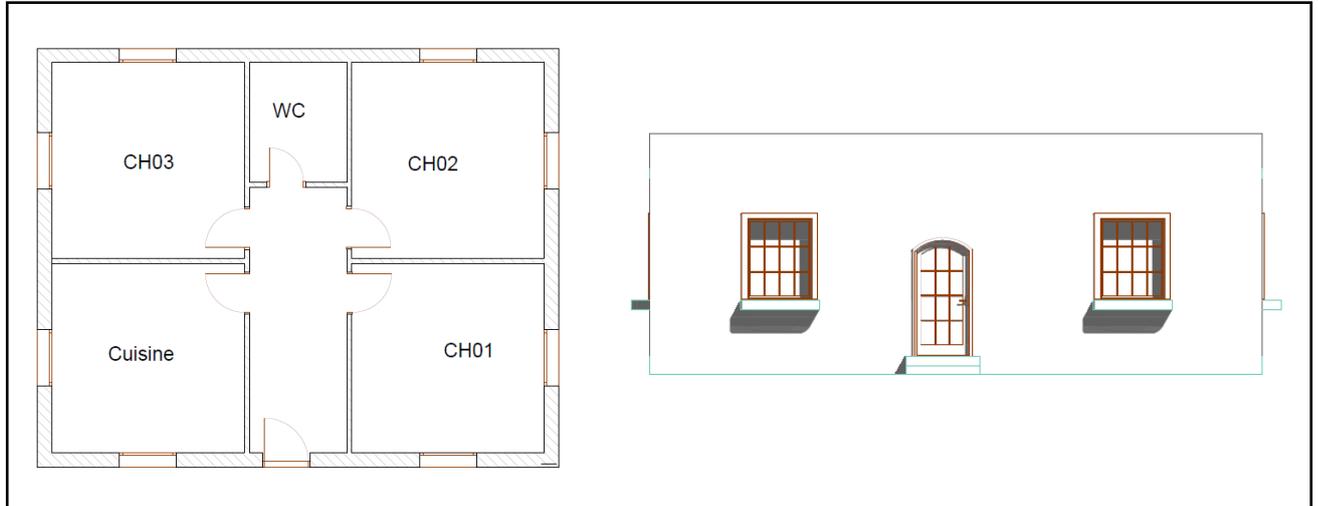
vue en plan et façade principale du logement. (Source BET)
